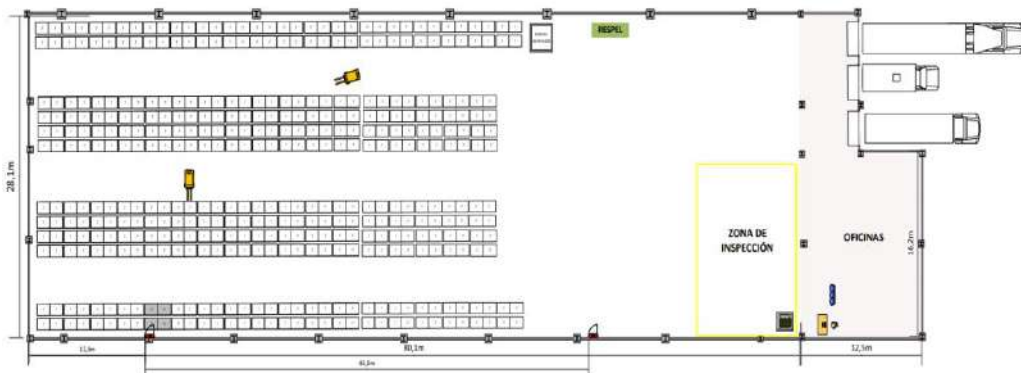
Plano de ubicación de estanterías. Fuente: Alpopular 2025.
